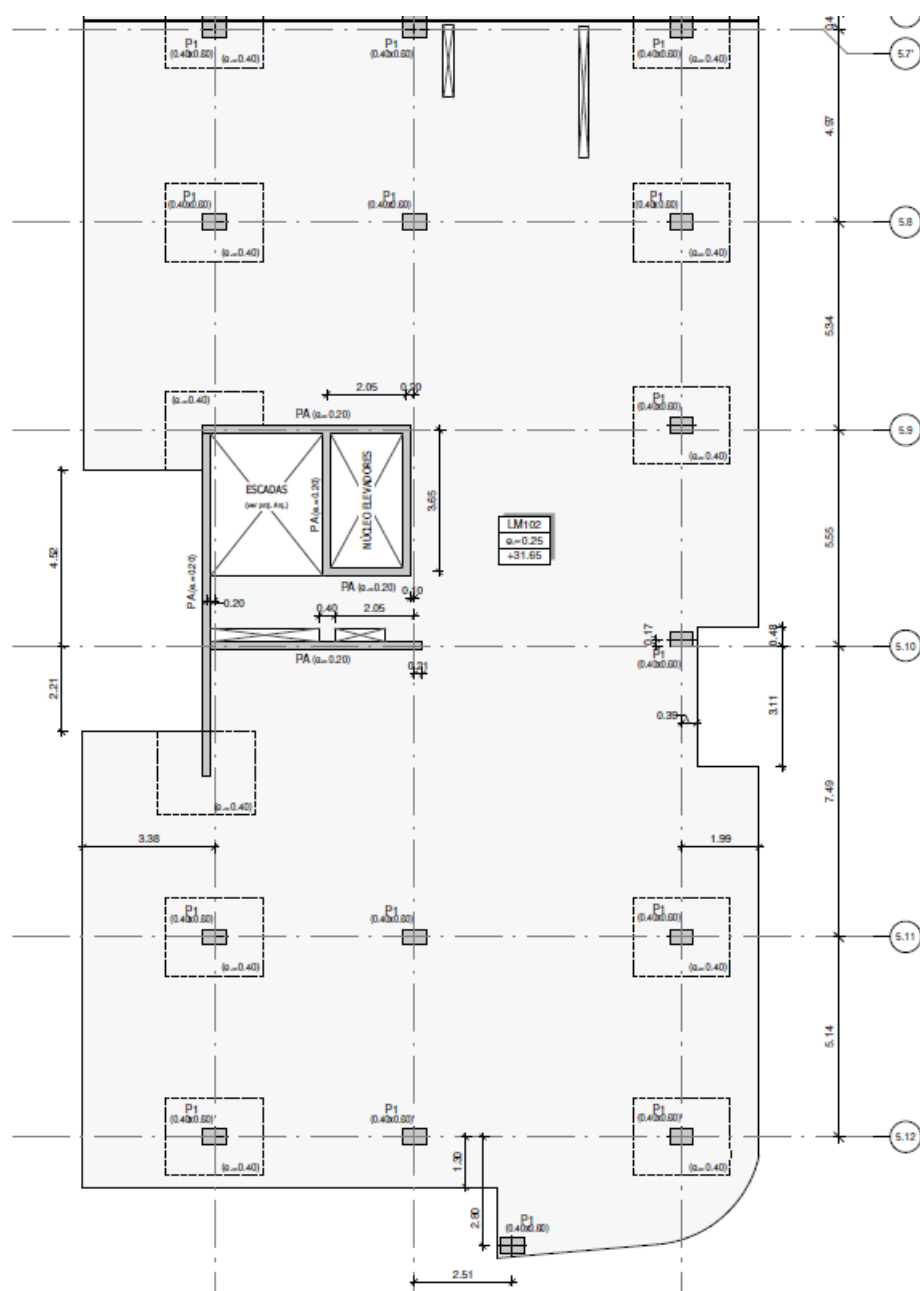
Planta estrutural piso 5 ao 7 (Revit)
